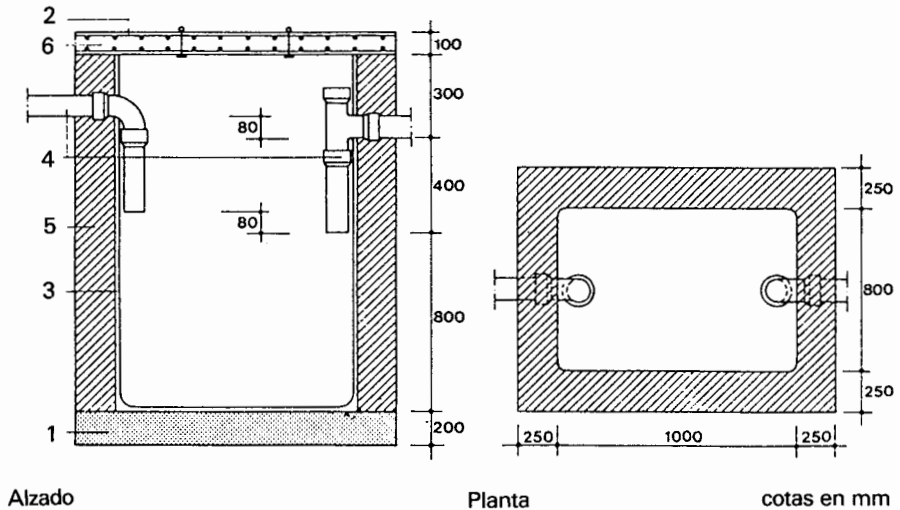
Separador de grasas y fangos. 1. Solera de hormigón. 2. Armadura. 3. Enfoscado con mortero. 4. Tubería de fibrocemento. 5. Muro. 6. Losa-tapa.
